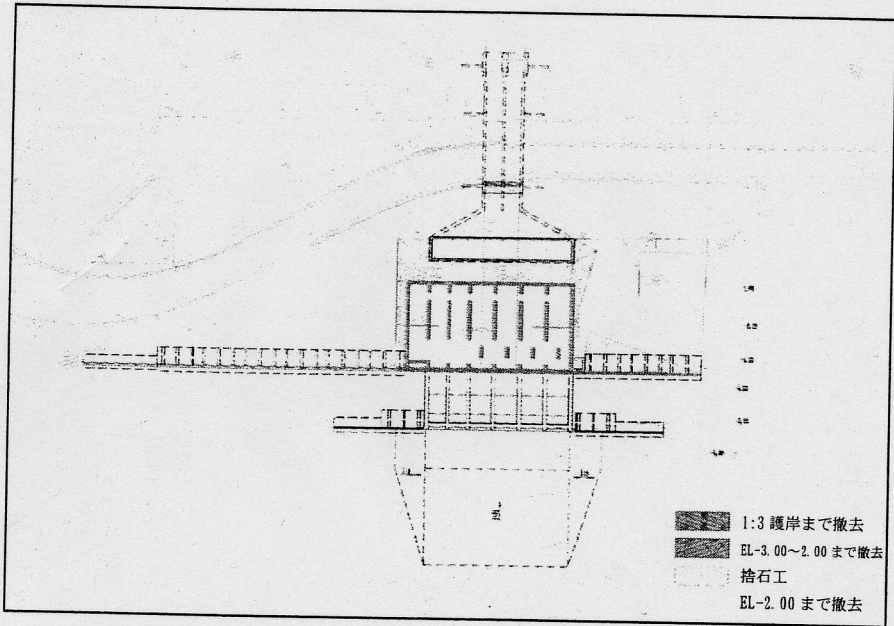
本庄排水機場撤去（二次撤去）の平面図
